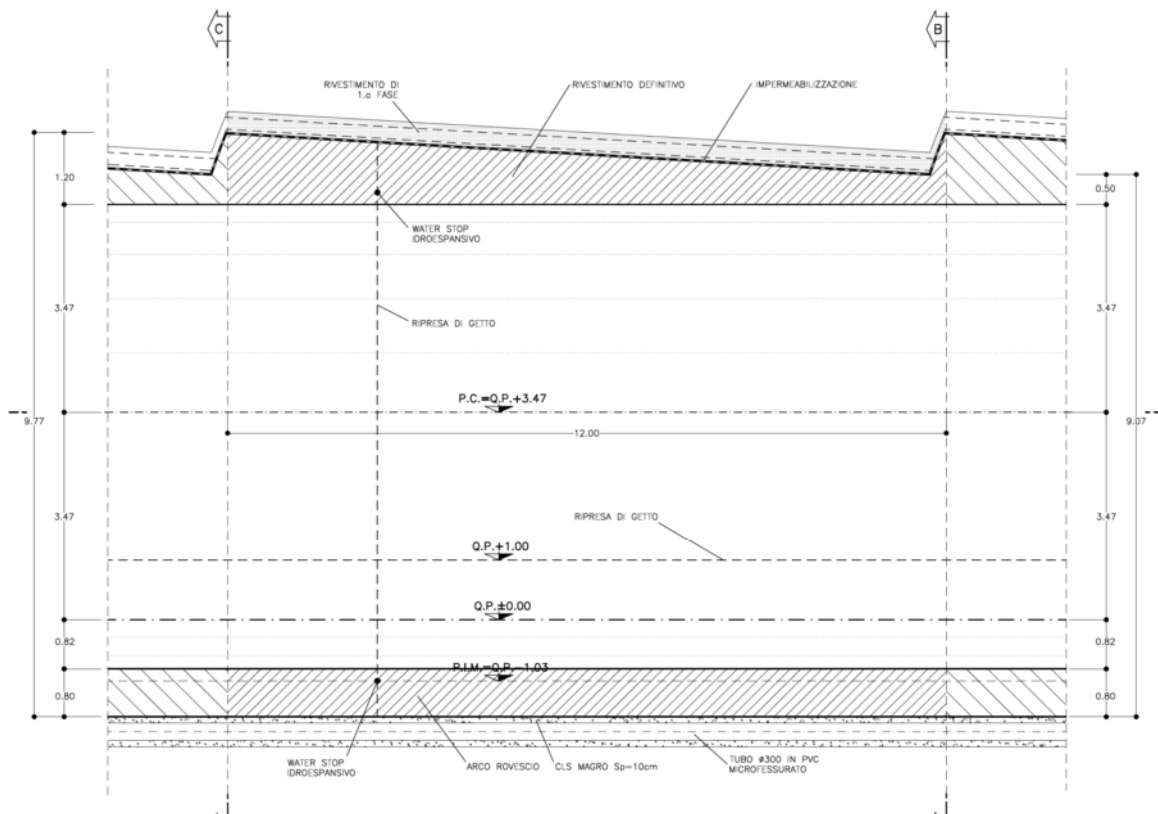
Sezione Tipo C2V – Carpenteria – Profilo longitudinale
